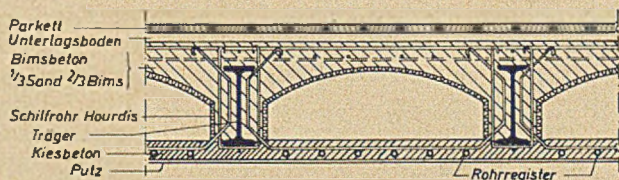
Stahlträgerdecke mit Betonunterdecke.
